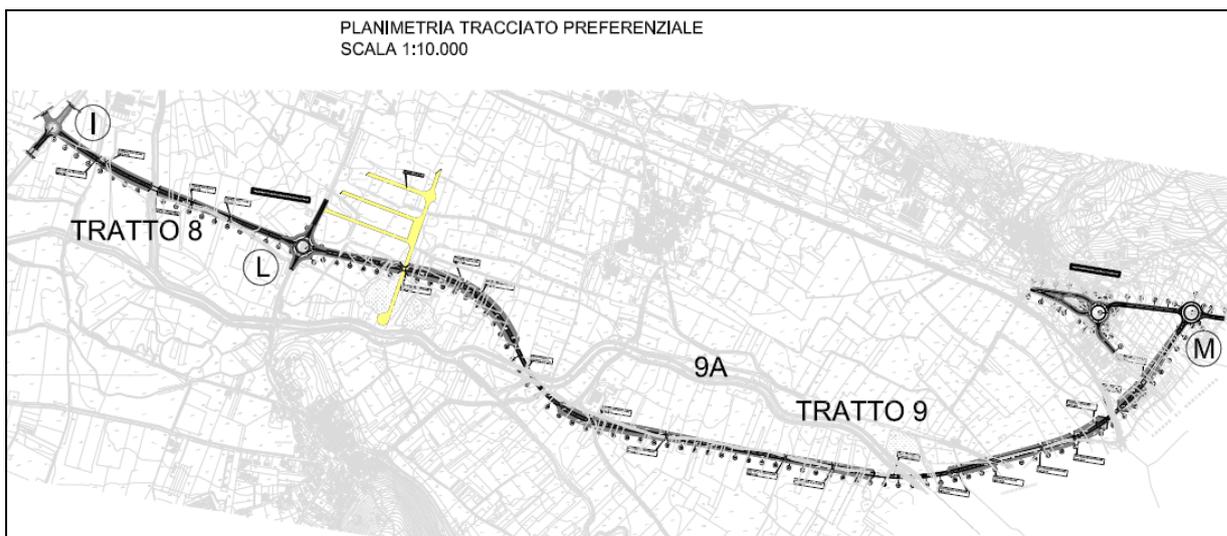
Planimetria LOTTO A con Alternativa di progetto 9A
